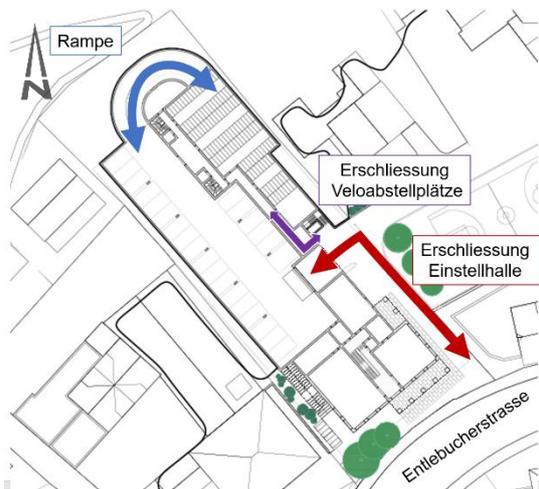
Erschliessung Einstellhalle Erdgeschoss
